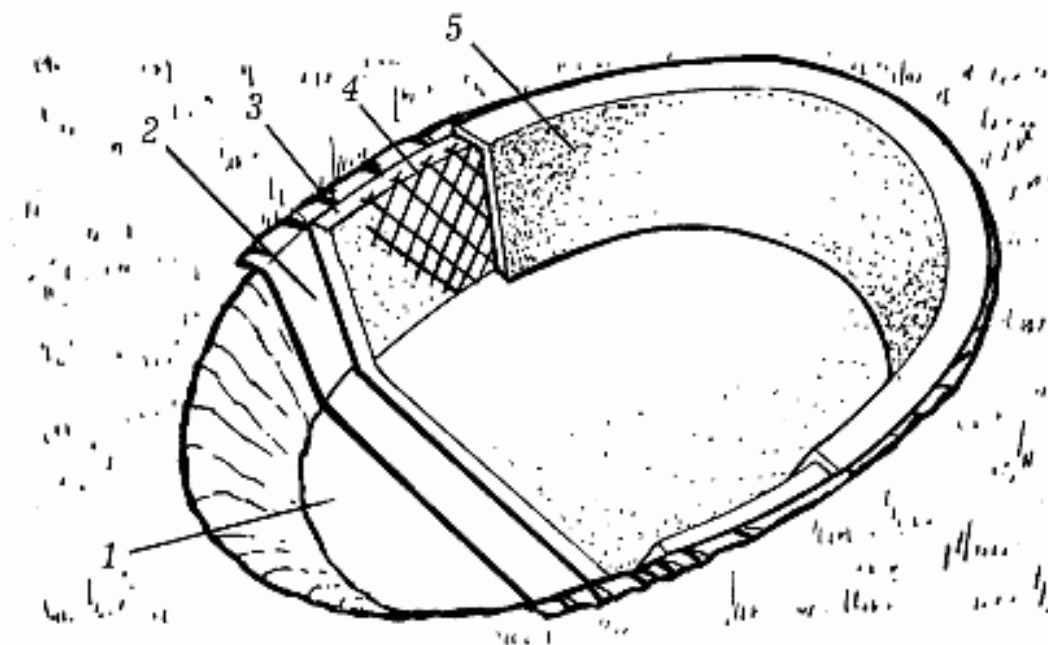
Этапы работы при строительстве пруда с гидроизоляцией из бетона: 1 – рытье котлована; 2 – установка гидроизоляции; 3 – первое бетонирование; 4 – установка арматуры; 5 – повторное бетонирование
